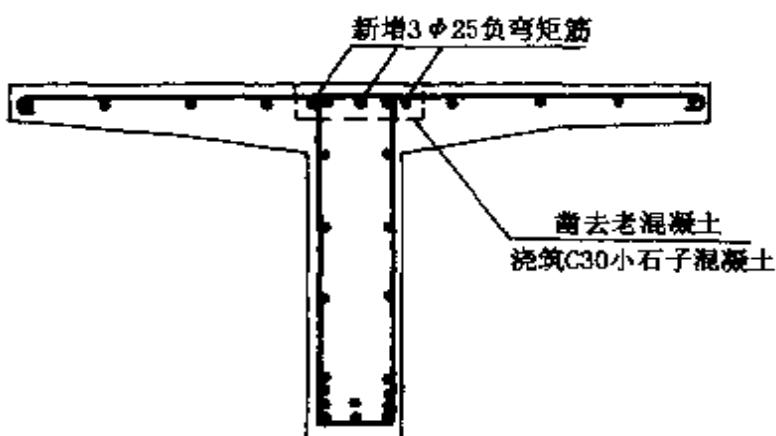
在 T 梁顶上新增负弯矩钢筋并浇筑混凝土
